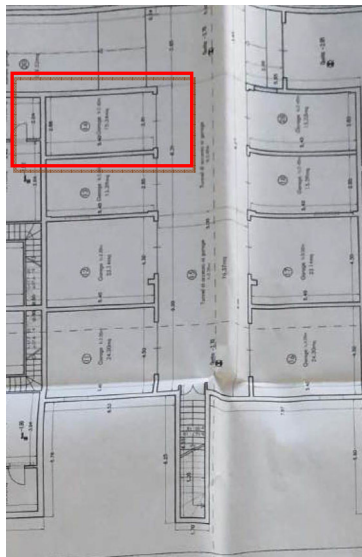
Planimetria del box tratta dalla DIA variante_19-04-07-n 030934
